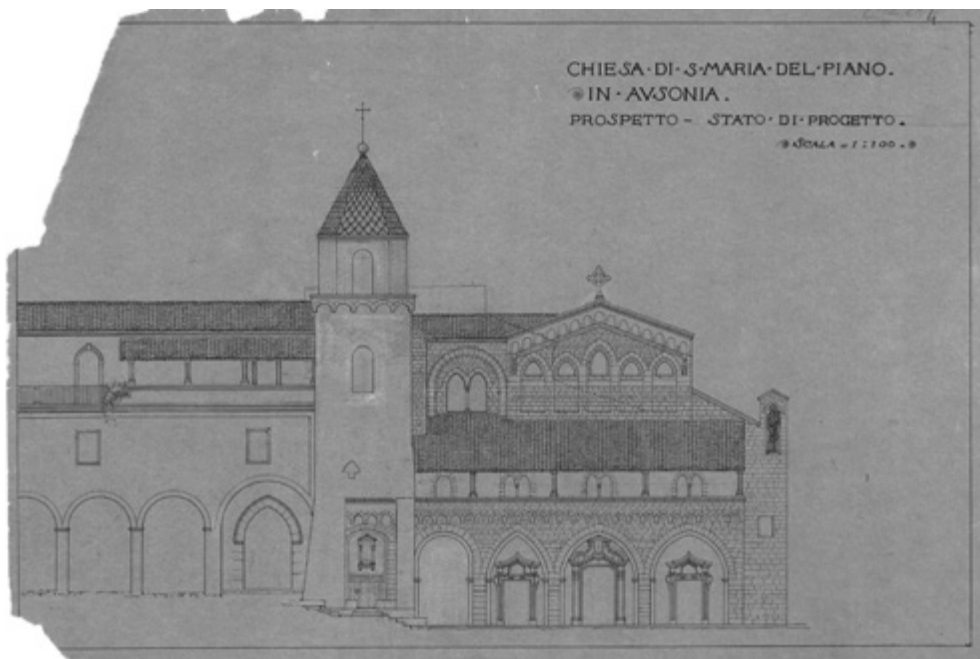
Alzado de la nueva fachada de Ausonia, Santa María del Piano. Imagen: Gustavo Giovannoni, 1916.
